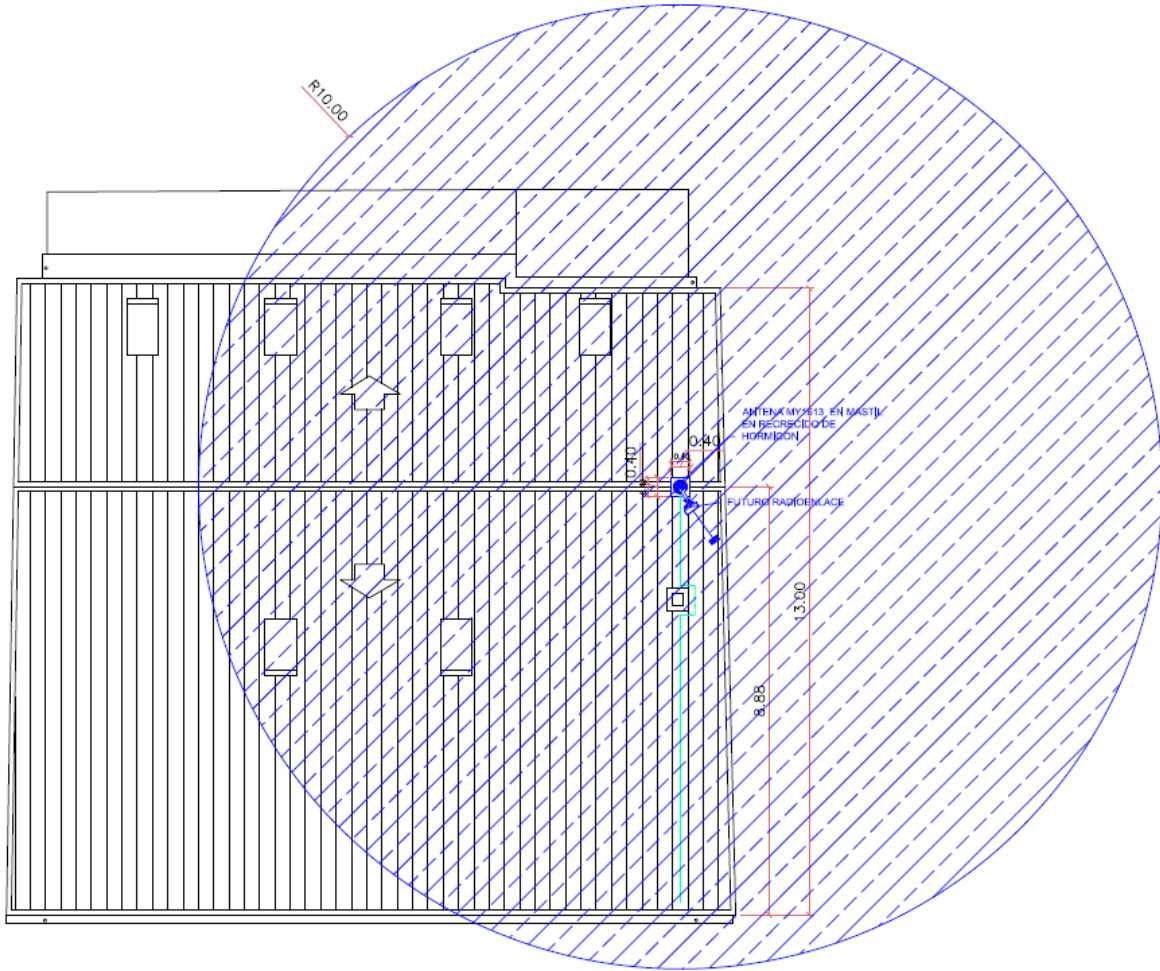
Detalle de planta de la antena a colocar en el emplazamiento de ILUNDAIN EB con paralelepípedo según Ley Foral 10/2002. (Paralelepípedo de 10 x 6 x 4 m)
